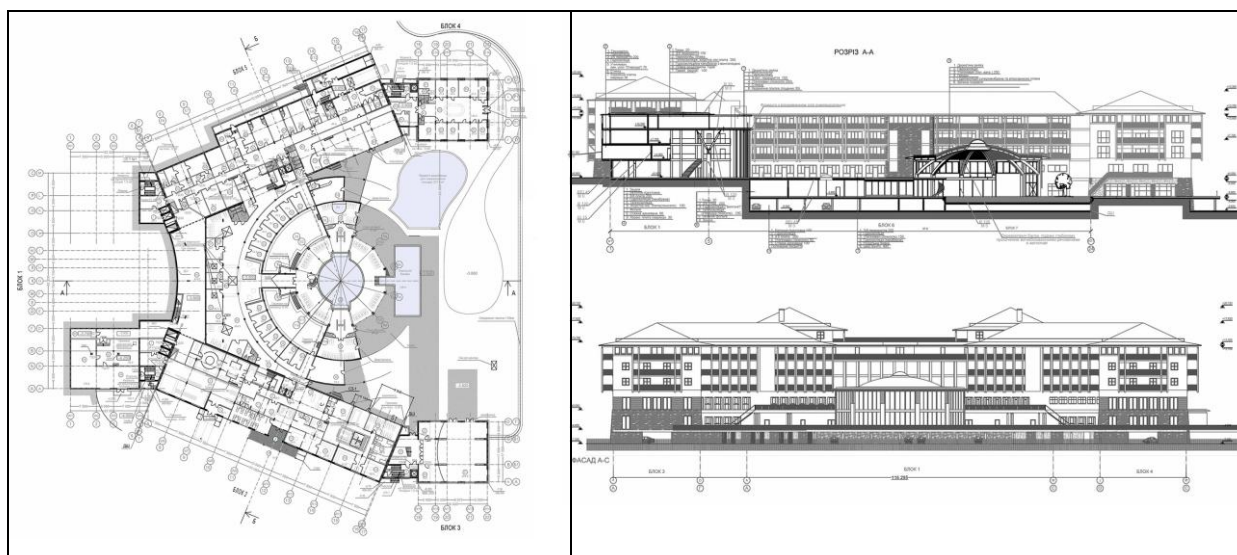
План, розріз та фасад готелю Radisson Blu Resort
